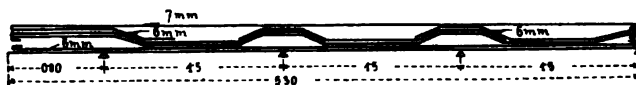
Armierungsschema eines Siegwartbalkens für die Galerie am Mythensteintunnel.
